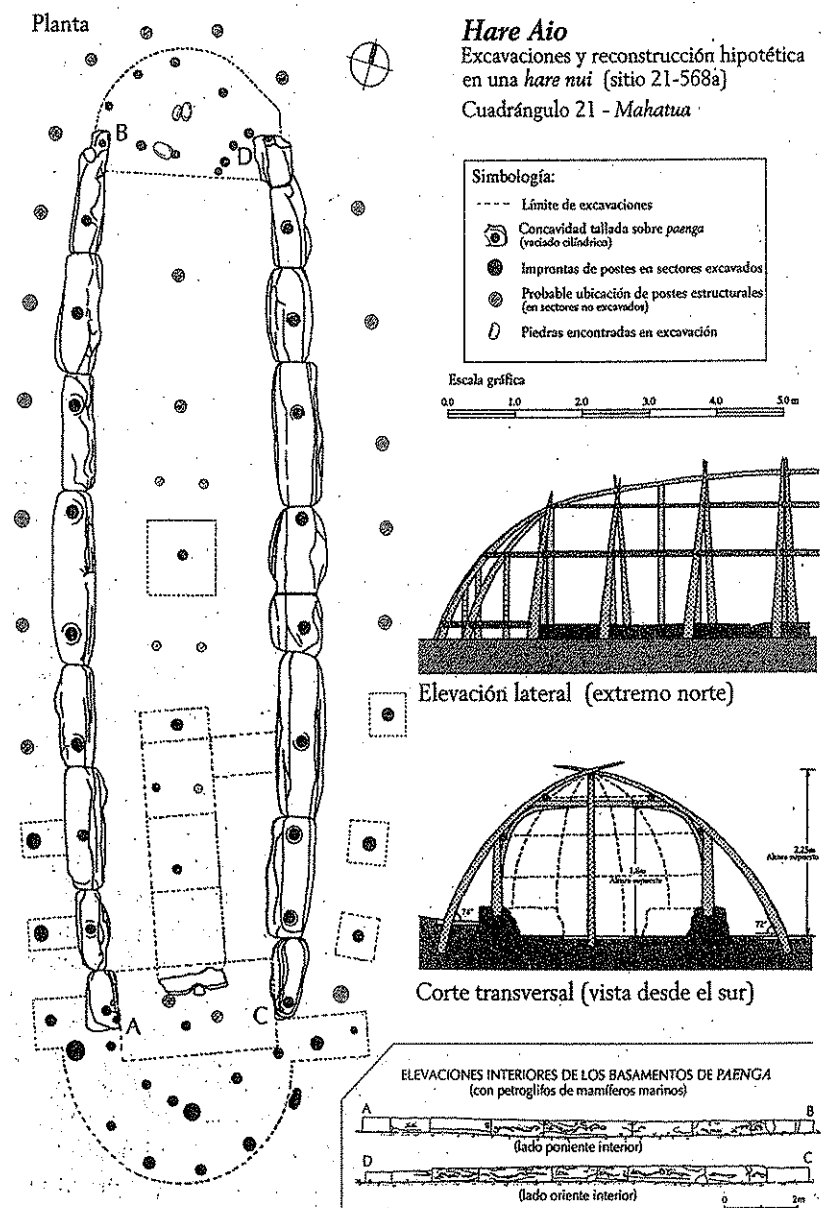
Plano de planta de *Hare Aio* con indicación de sectores excavados, reconstrucción hipotética de la superestructura y elevaciones de las caras interiores del basamento de *paenga* con ubicación de petroglifos existentes. Basado en Vargas *et al.*, 1992 (levantamiento y reconstrucción, R. Budd y R. Izaurieta).
